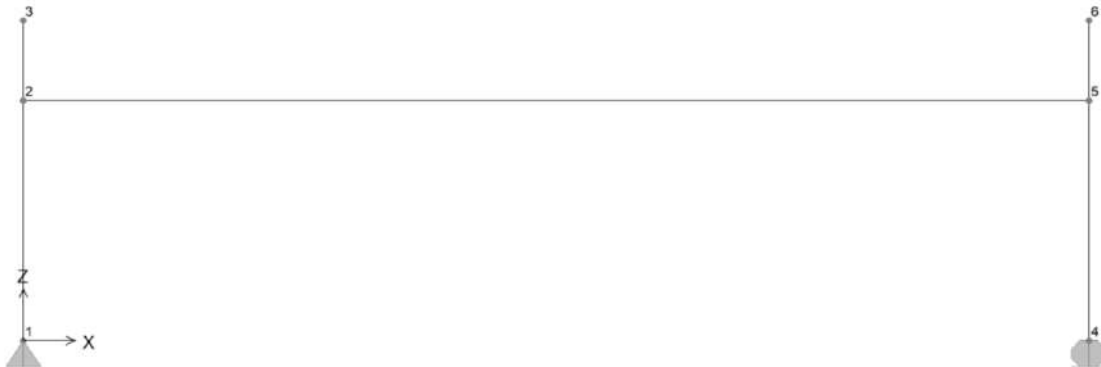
Modello di calcolo - Trasverso di appoggio - spalla
